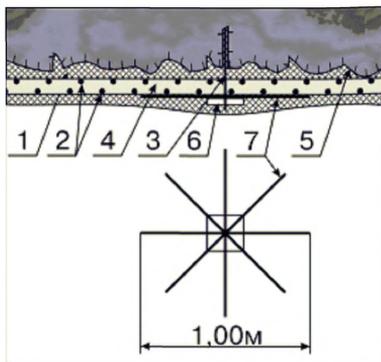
Армирование в области анкерной головки: 1 – торкрет-бетон; 2 – арматурная композитная сетка; 3 – анкер; 4 – слой раствора; 5 – бетонное основание; 6 – анкерная плита; 7 – двойная крестовина Ø10 мм [7]
